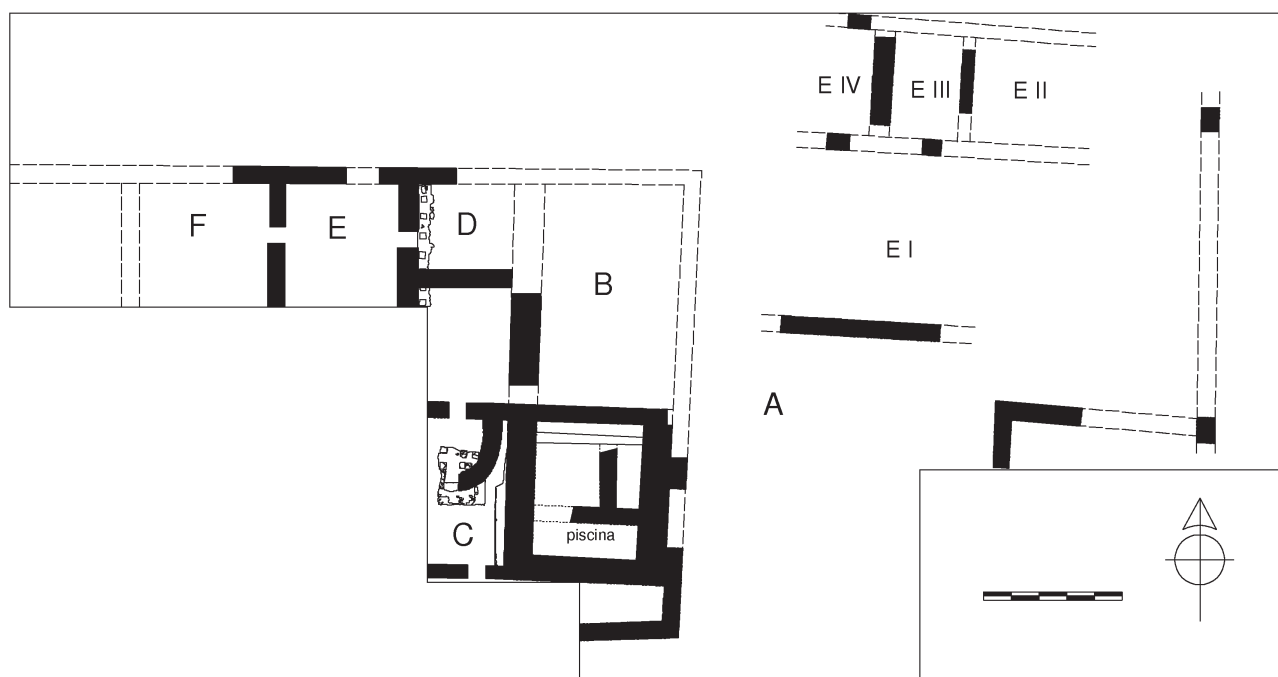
Planta de las termas de la calle Tapinería. Fase II.
